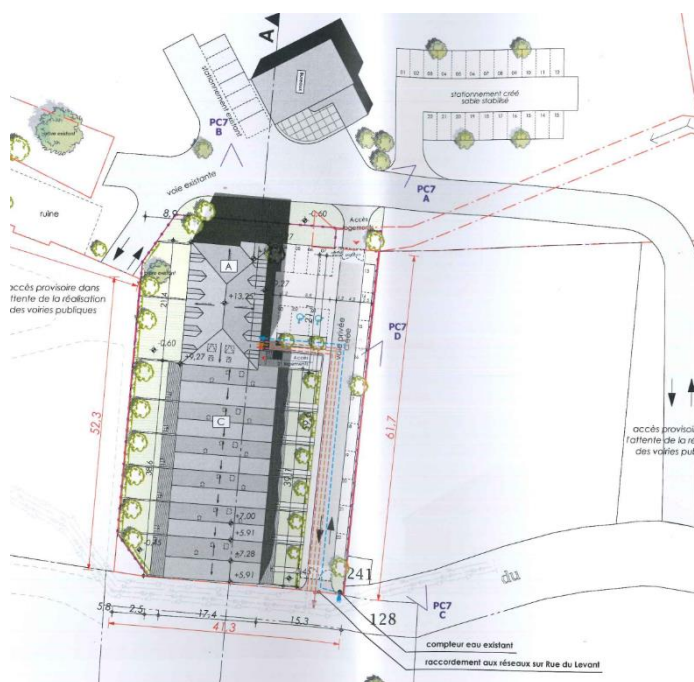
Plan masse des constructions à modifier des futurs bureaux et logements (Aamco, 2018)
